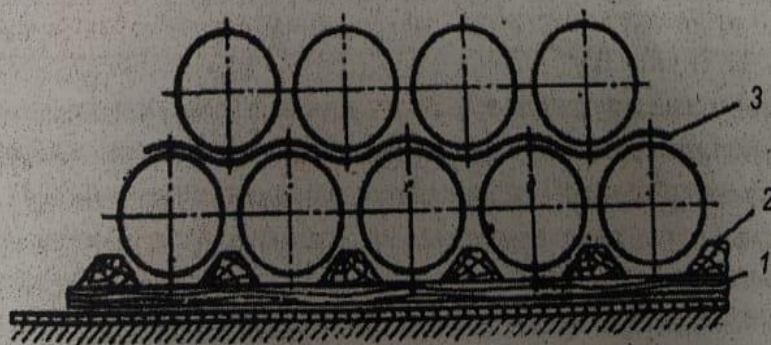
Складирование изделий круглого сечения: 1 — подкладка; 2 — упор; 3 — мягкая прокладка
